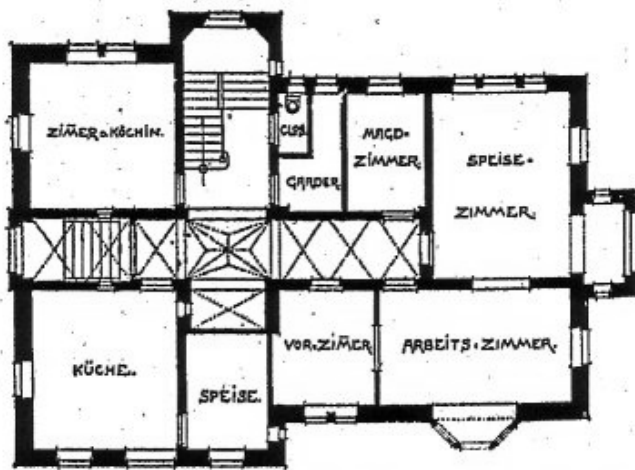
Villa Birkmeyer, Grundriß Erdgeschoß. Leonhard Romeis, 1891, Plan nach Norden ausgerichtet.
